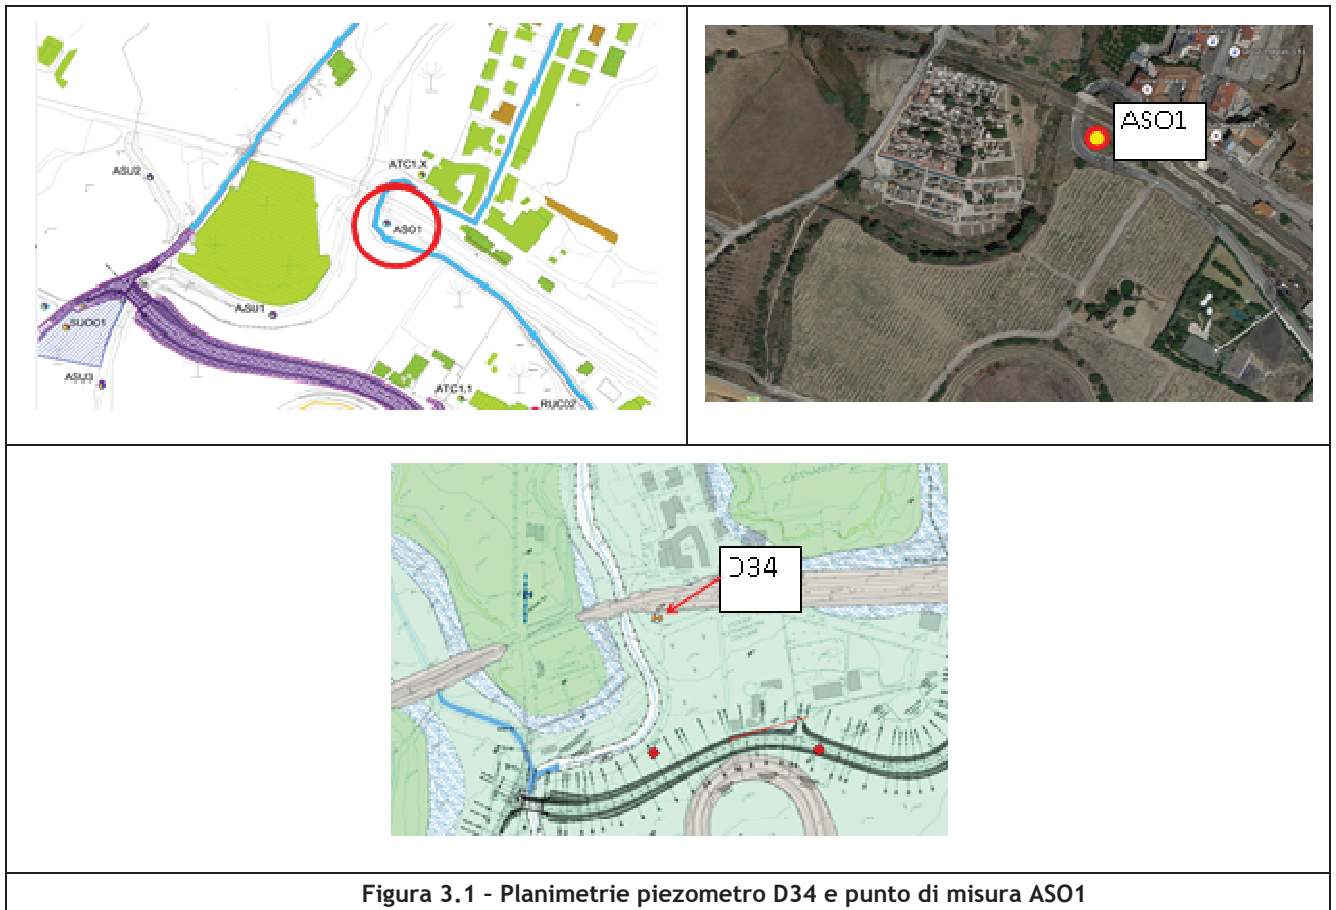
Planimetrie piezometro D34 e punto di misura ASO1
